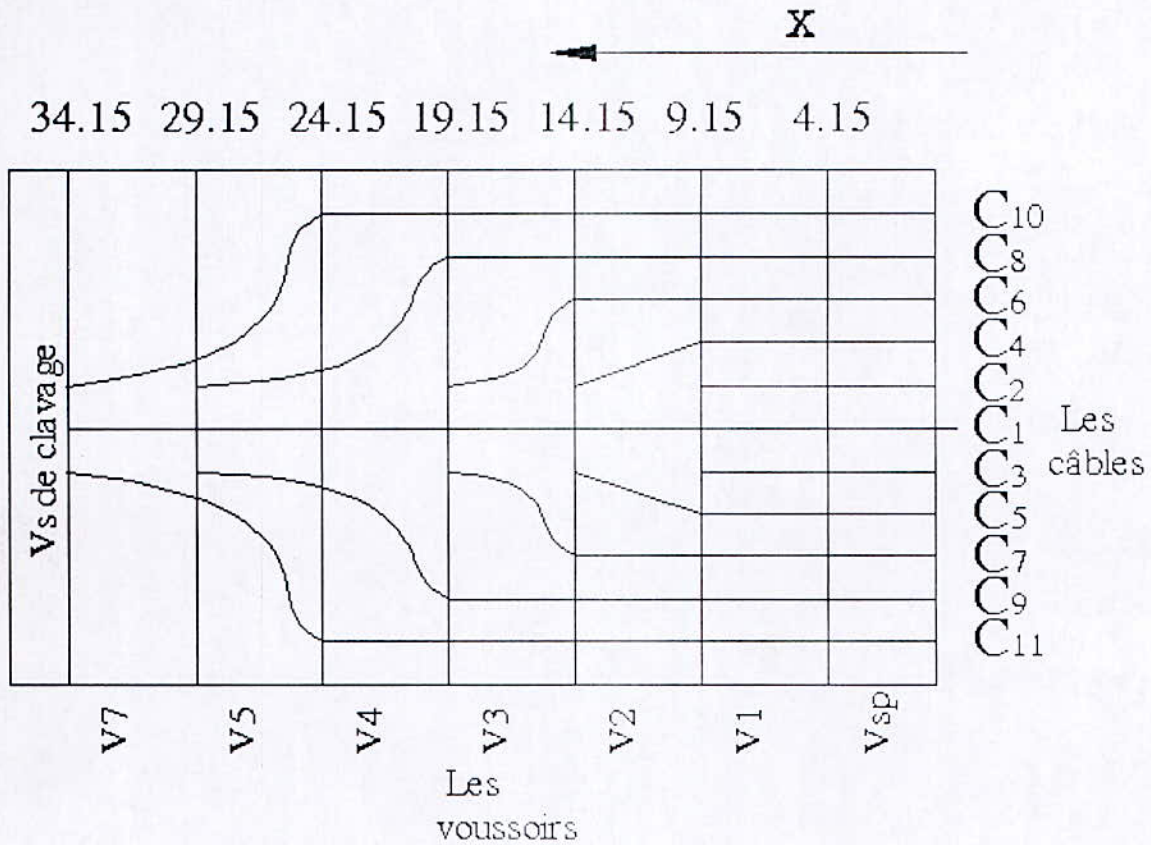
Disposition des câbles d'un fléau en élévation pour la travée centrale.
